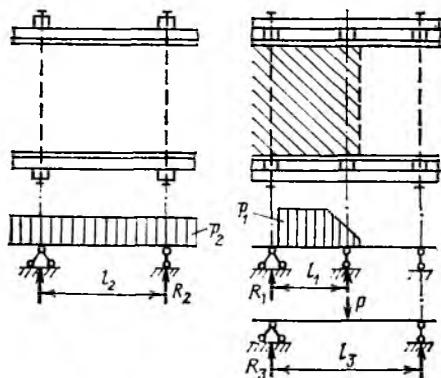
Схемы к расчету элементов деревянной опалубки для монолитной конструкции
